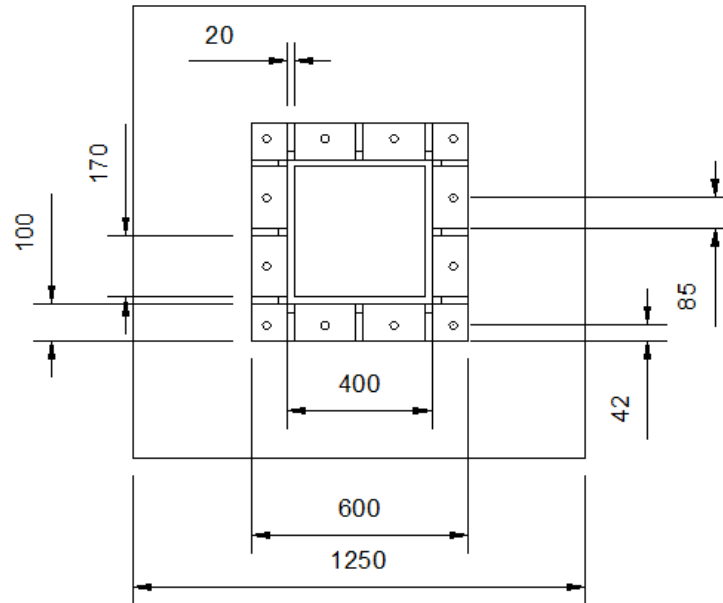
Vista en planta conexión columna tubular rectangular compuesta a cimentación con placa base empernada y rigidizada. Conexión 4.
